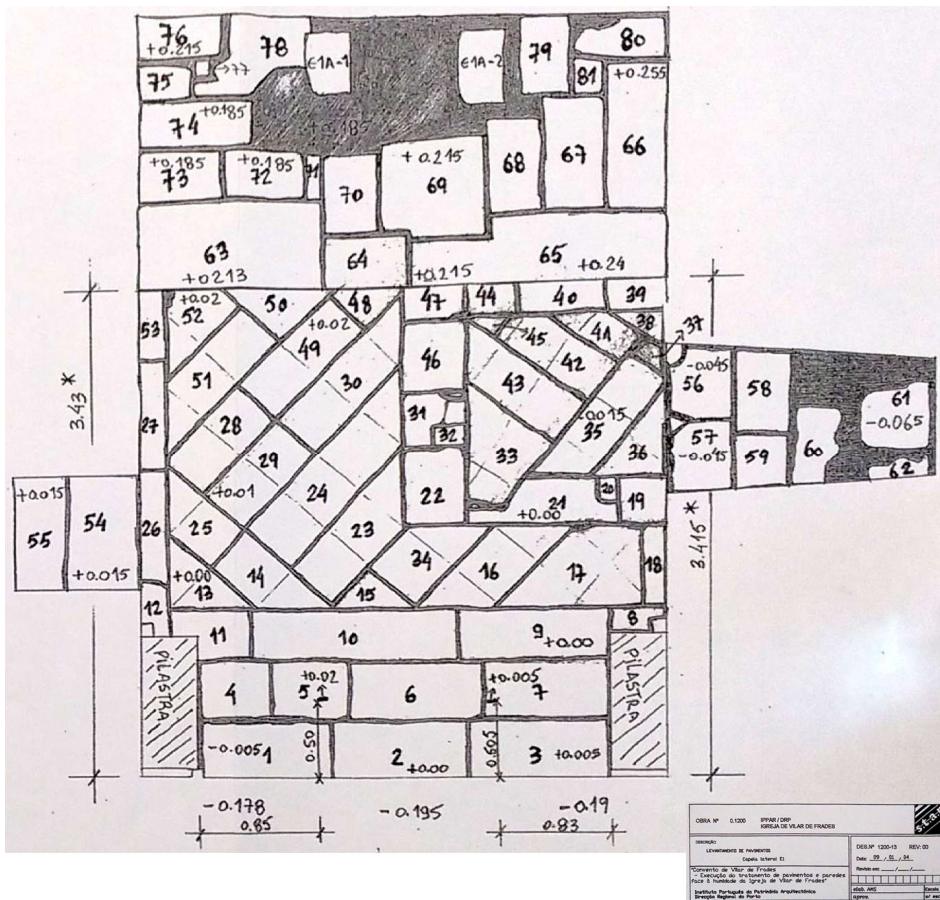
Levantamento do pavimento (A-3-19) da capela lateral para remontagem. Fonte: DRCN/S.T.A.P.
